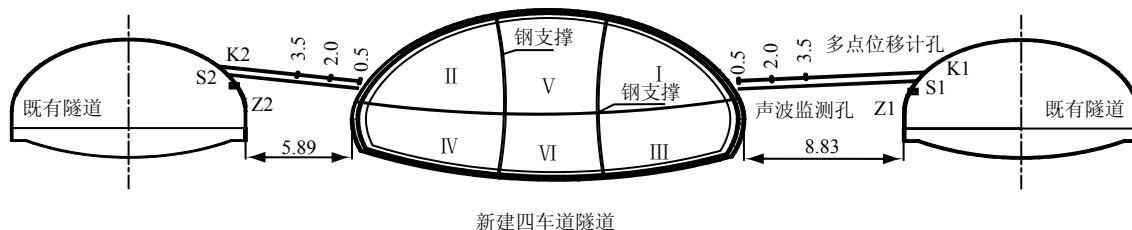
断面 ZK459+608 监测点埋设剖面图 (单位: m)
